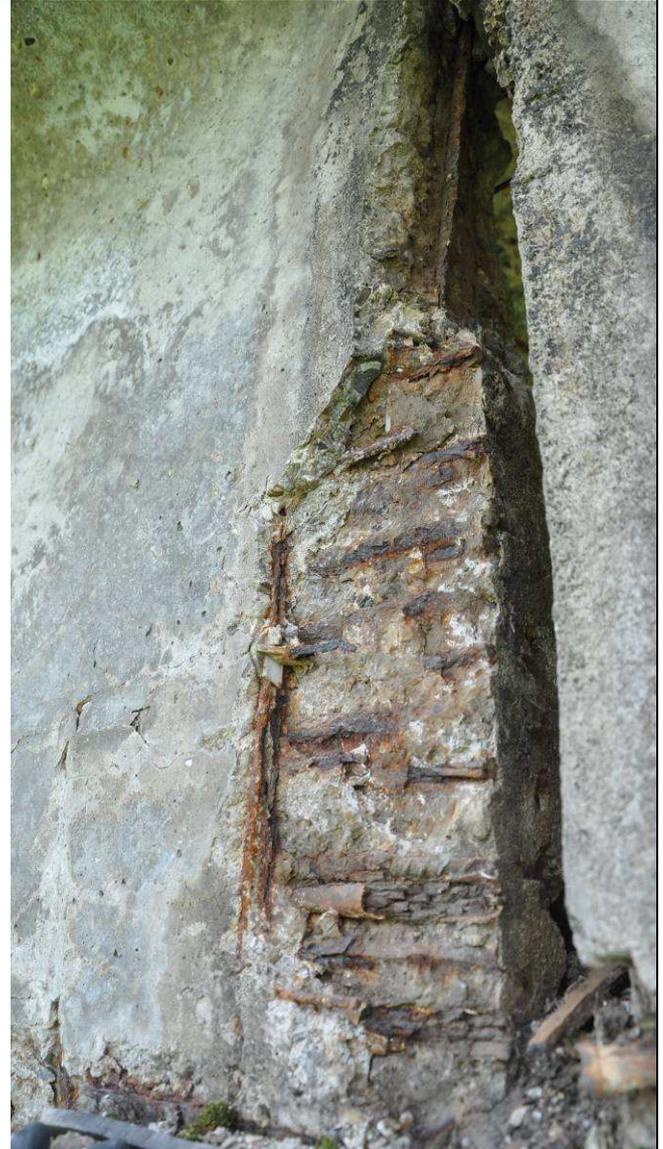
Vista di dettaglio del dissesto nella sezione di estremità di una trave in c.a.p. in corrispondenza dell'appoggio su una pila intermedia
